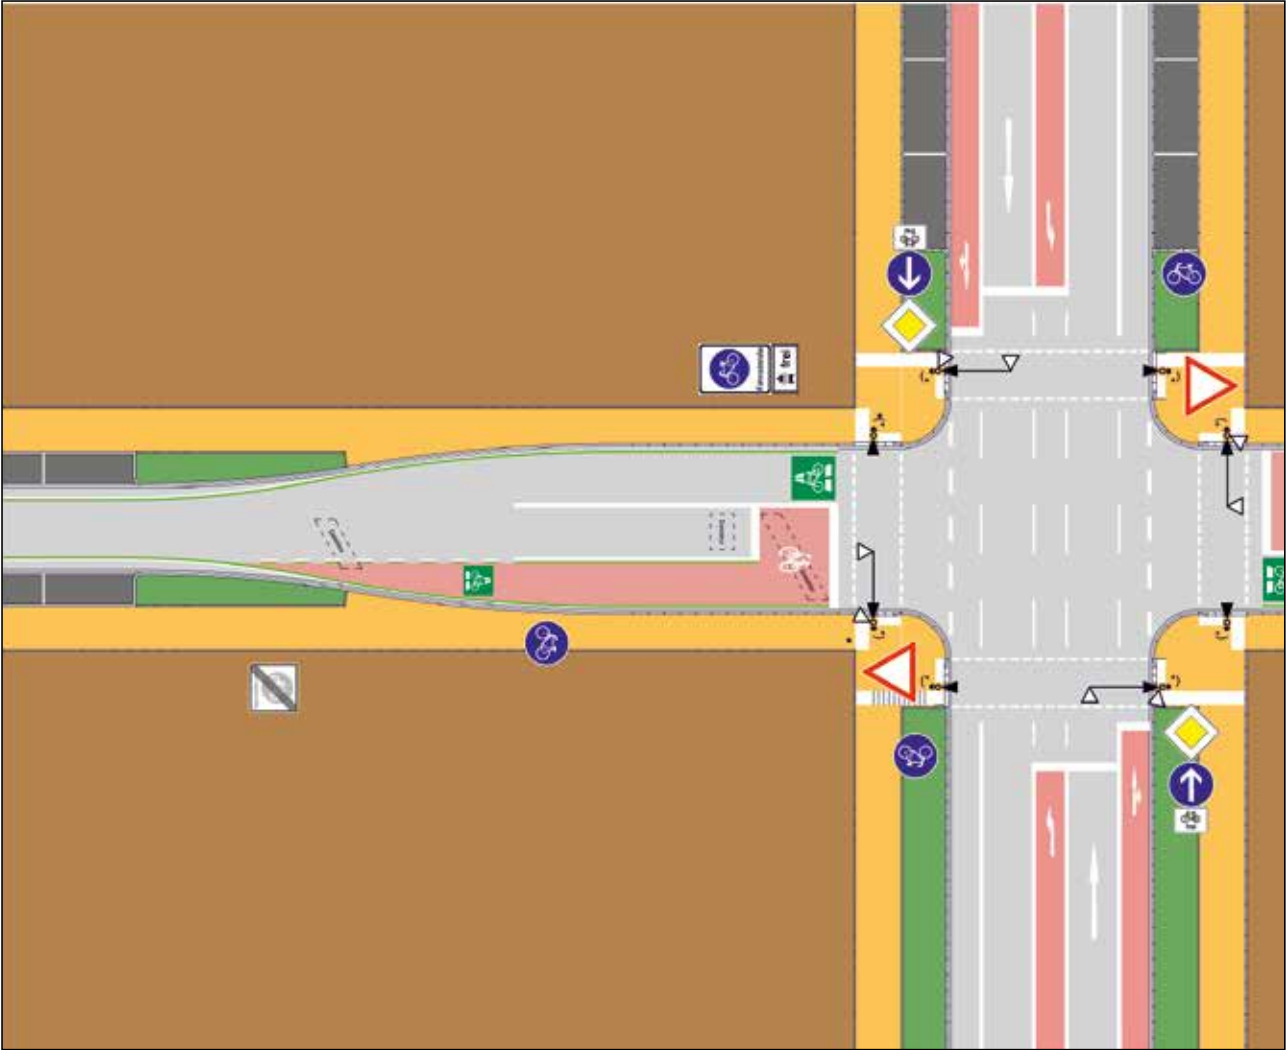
Kreuzung einer Hauptverkehrsstraße und einer RSV als Fahrradstraße mit Lichtsignalanlage (Hauptrichtungs-Grün-Steuerung) und aufgeweitetem Radaufstellbereich (siehe auch Anhang 11.1.6)
